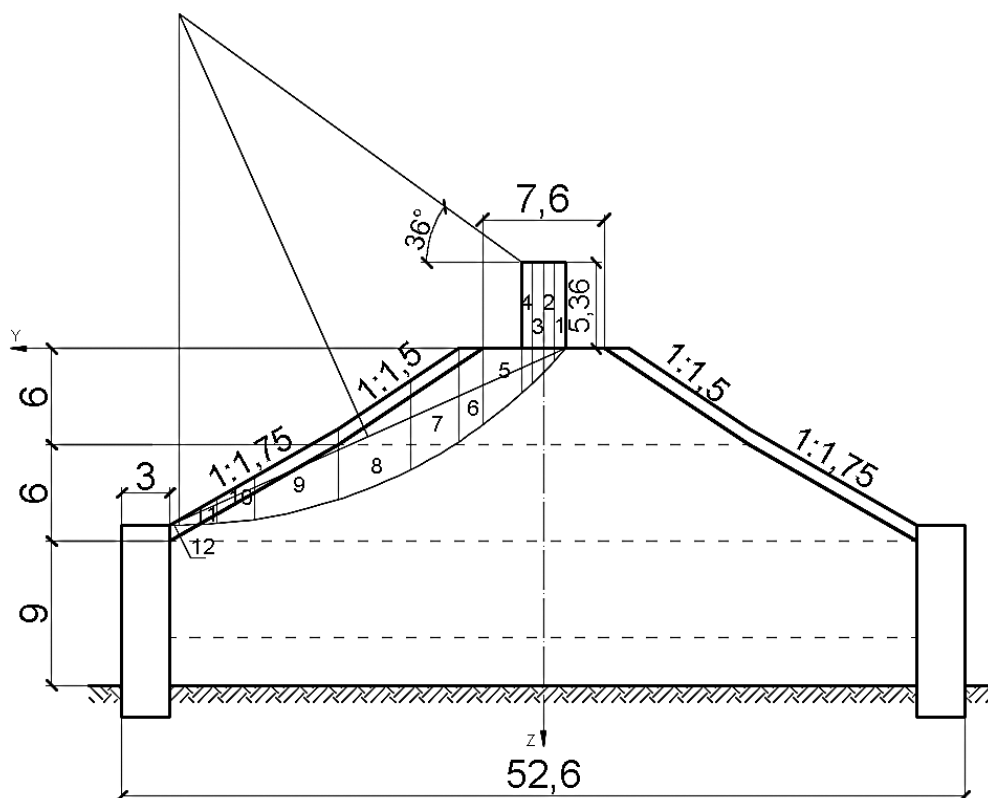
Конструкция насыпи, усиленная габионными подпорными стенками, расчетная схема поверхности разрушения по верху стенки
